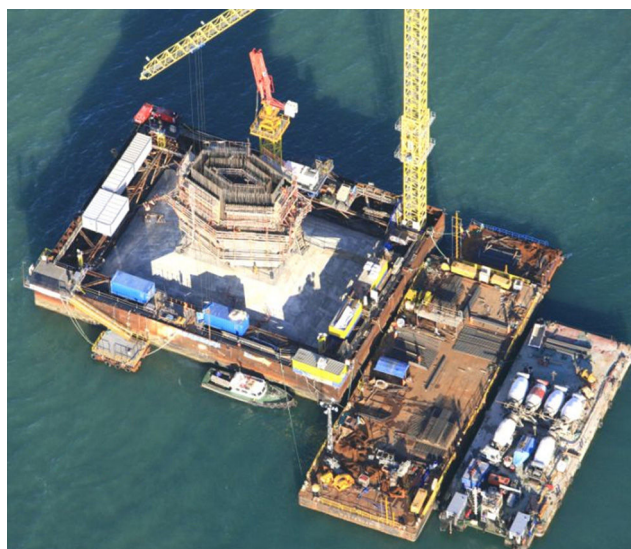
Ejecución de fuste de torre con encofrado autotrepante.
